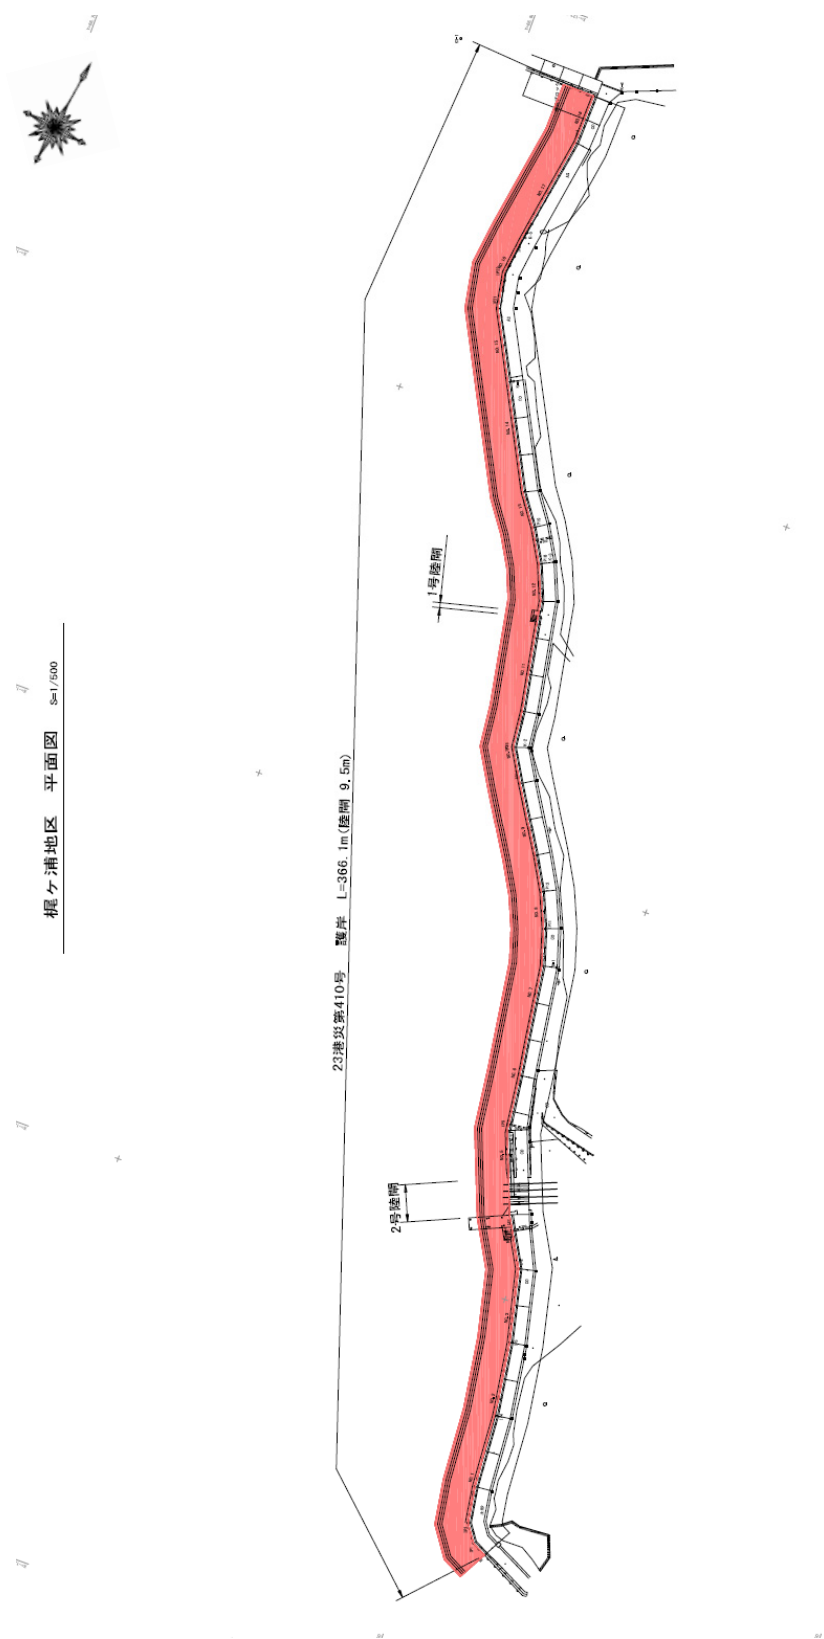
86 No. 4 梶ヶ浦地区_護岸の平面図 (復旧後)
